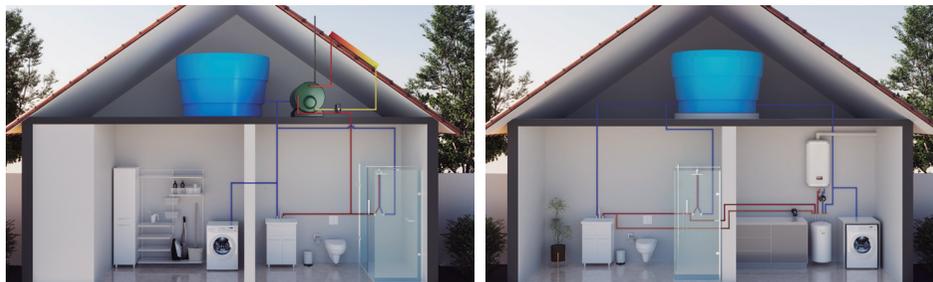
EXEMPLOS DE INSTALAÇÃO DA BOMBA CIRCULADORA
